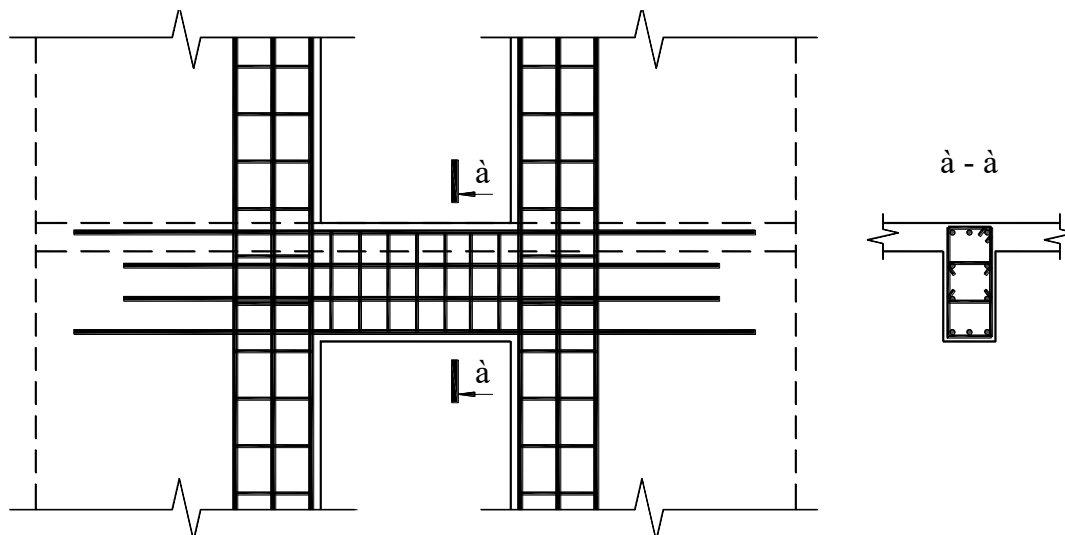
Армирование связующей балки продольными арматурными стержнями и вертикальными хомутами
